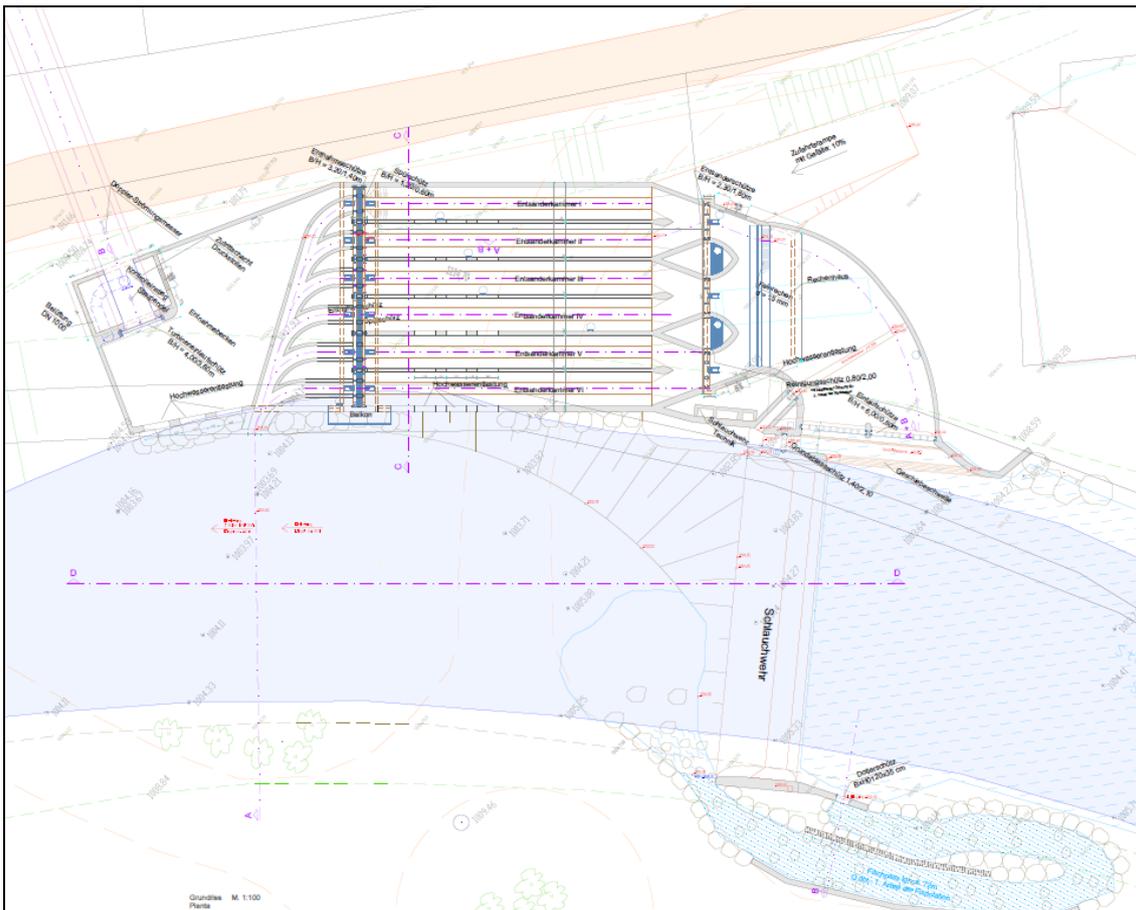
Planimetria di progetto: opera di presa con passaggio pesci (fonte: Tavole progettuali)
